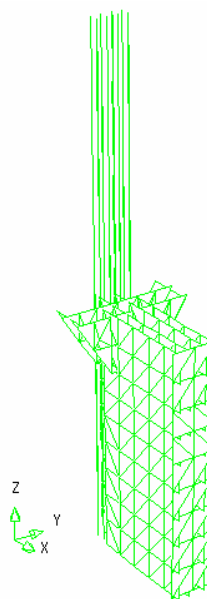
Perspectiva das armaduras da zona da lâmina de apoio.
